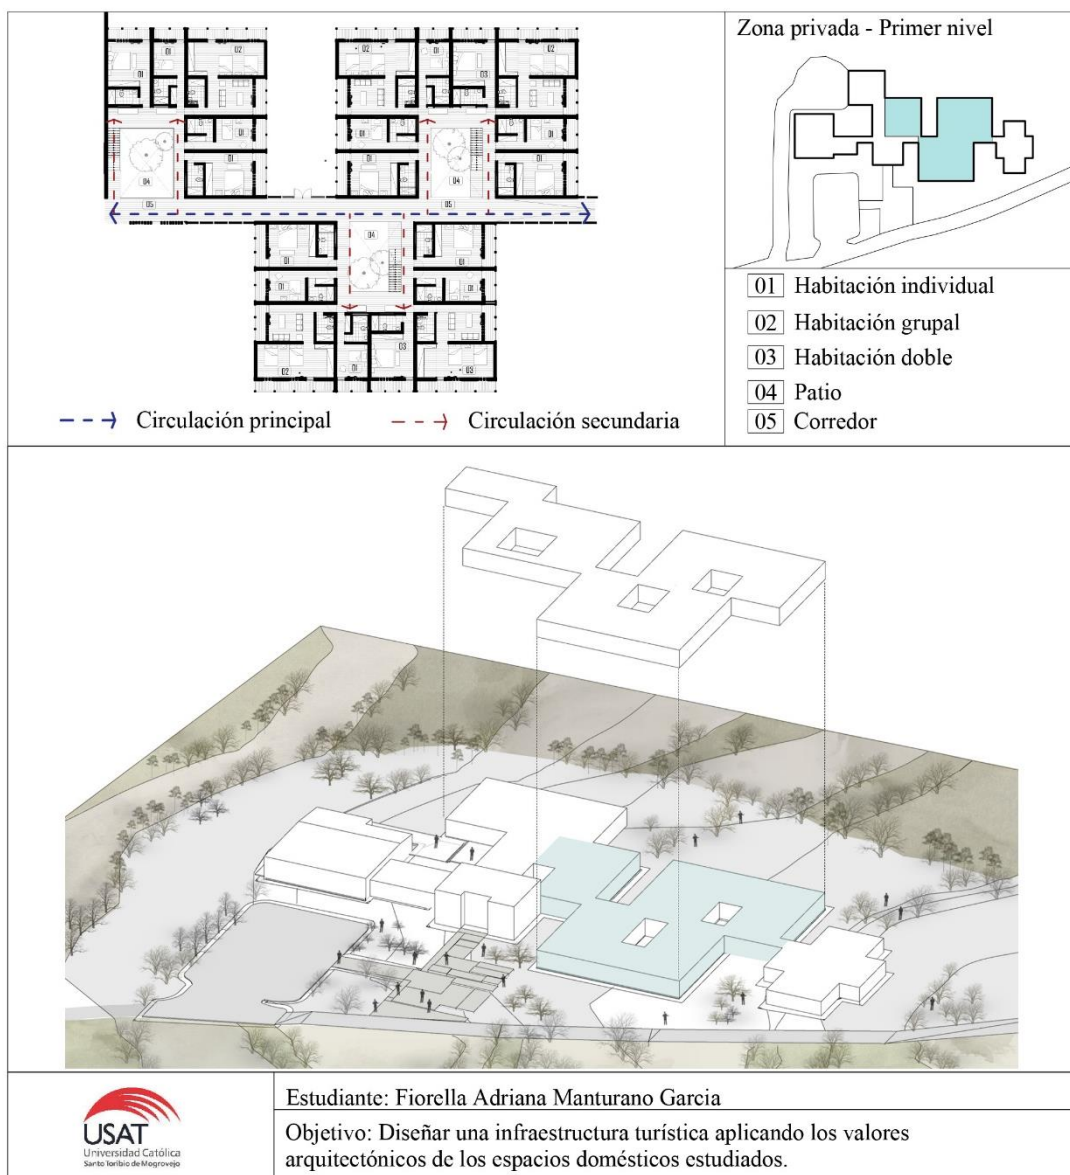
Zona Privada Plano / Axonometría . Fuente: Elaboración Propia.
